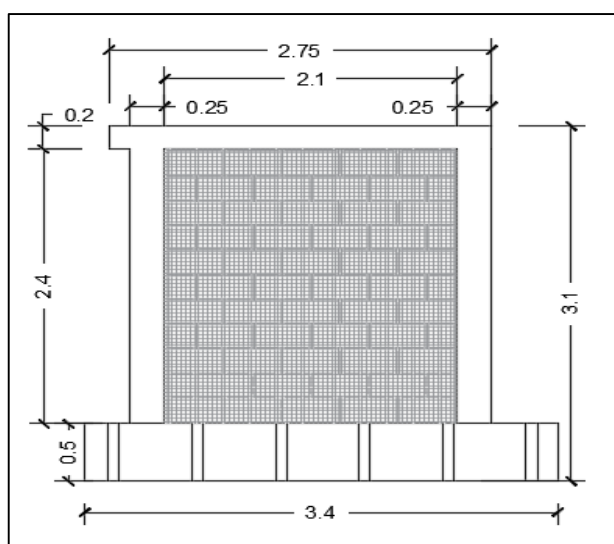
Esquema del pórtico de hormigón, (dimensiones en m)
